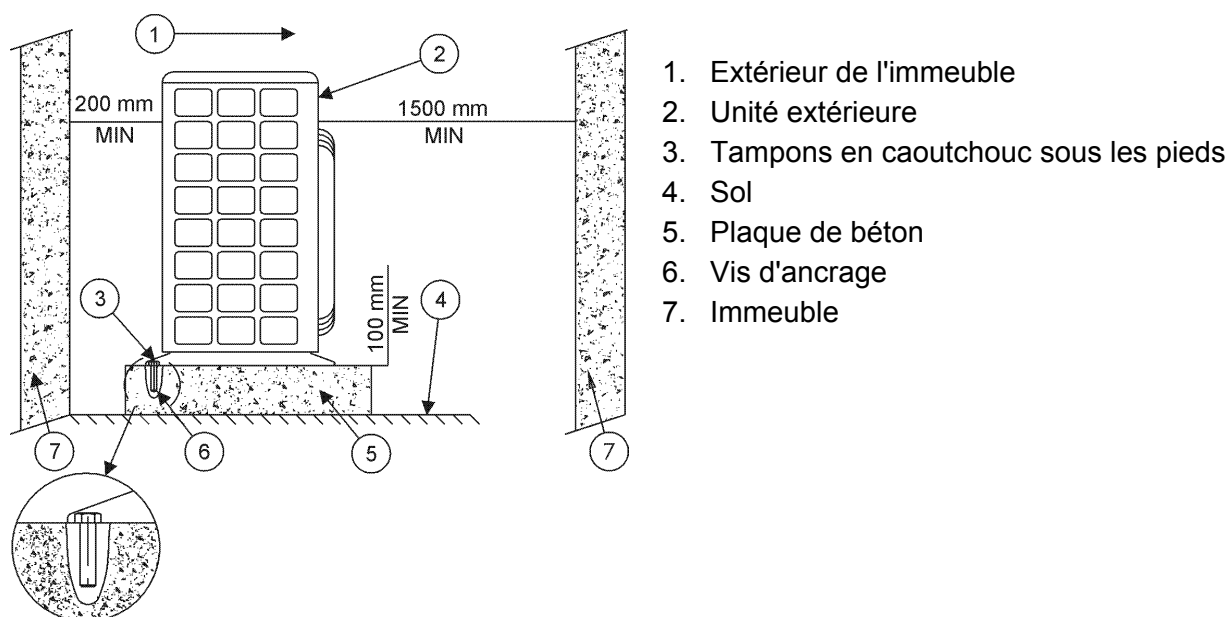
Installation de l'unité extérieure sur une plaque de béton
